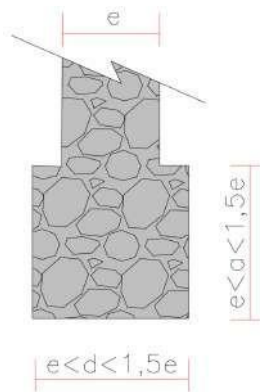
Relación muro de cimentación vivienda. Fuente propia
